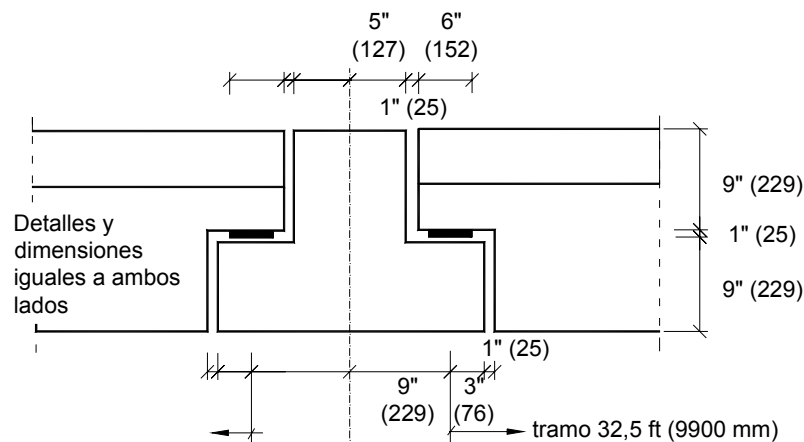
Detalles de la viga con extremos entallados y de la viga T invertida
